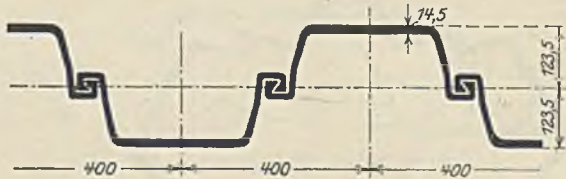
Neue Bauart Larssen mit gewalztem Schloß.
